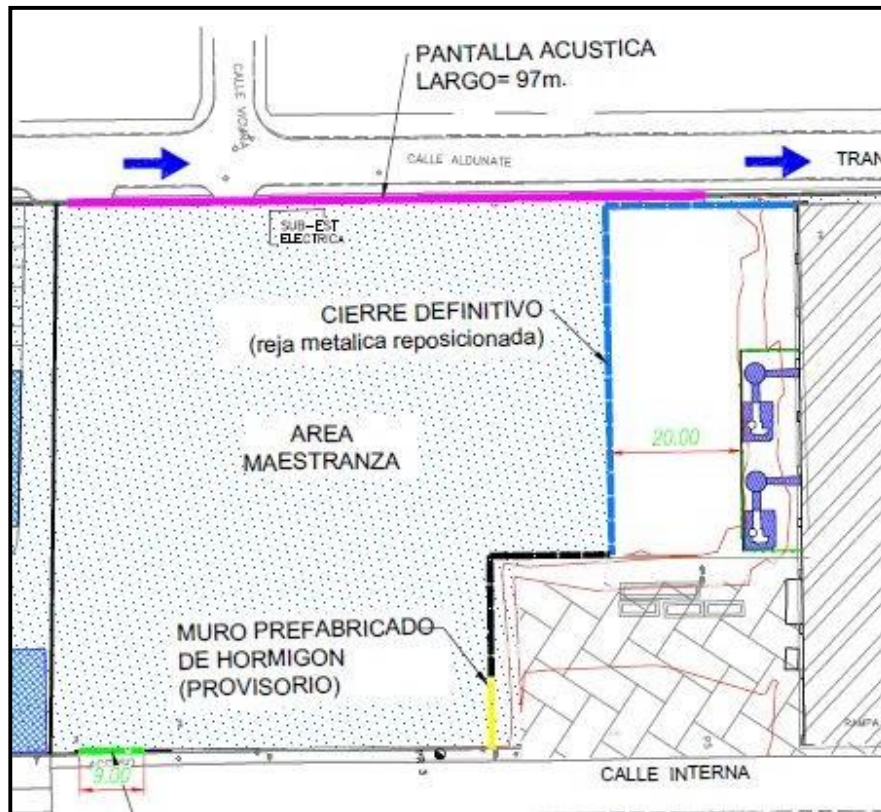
Planta de Sector Maestranza, Disposición de Pantallas Acústicas
